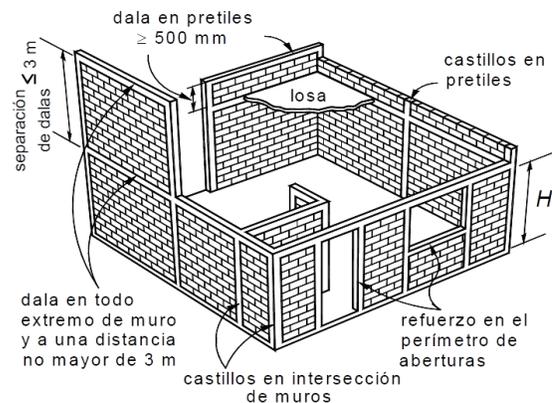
Elementos de refuerzo en muros de mampostería confinada (NTCDCEM 2004)
